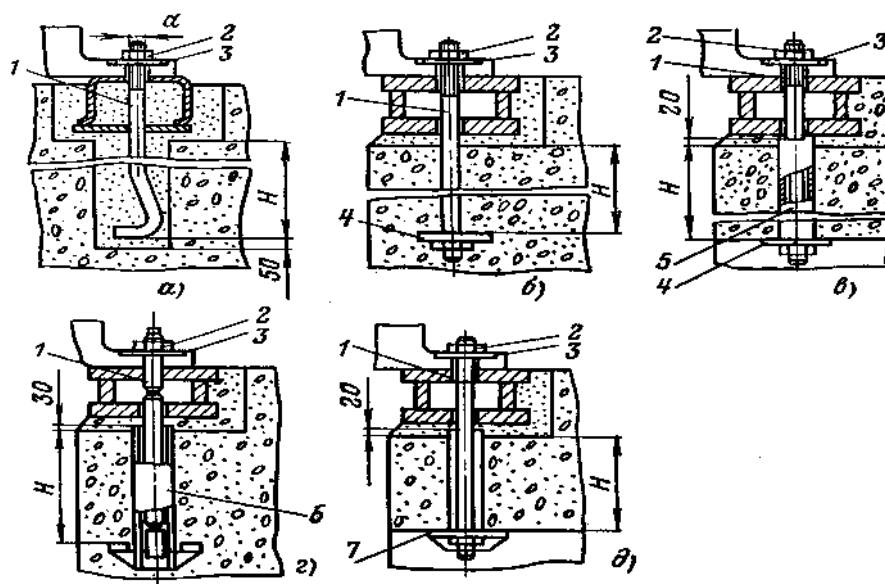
Установка фундаментных болтов (а, б – крепление глухое; в, г, д – крепление съемное): 1 – фундаментный болт; 2 – гайка; 3 – шайба; 4 – плита; 5 – труба; 6 – арматура анкерная; 7 – плита анкерная
